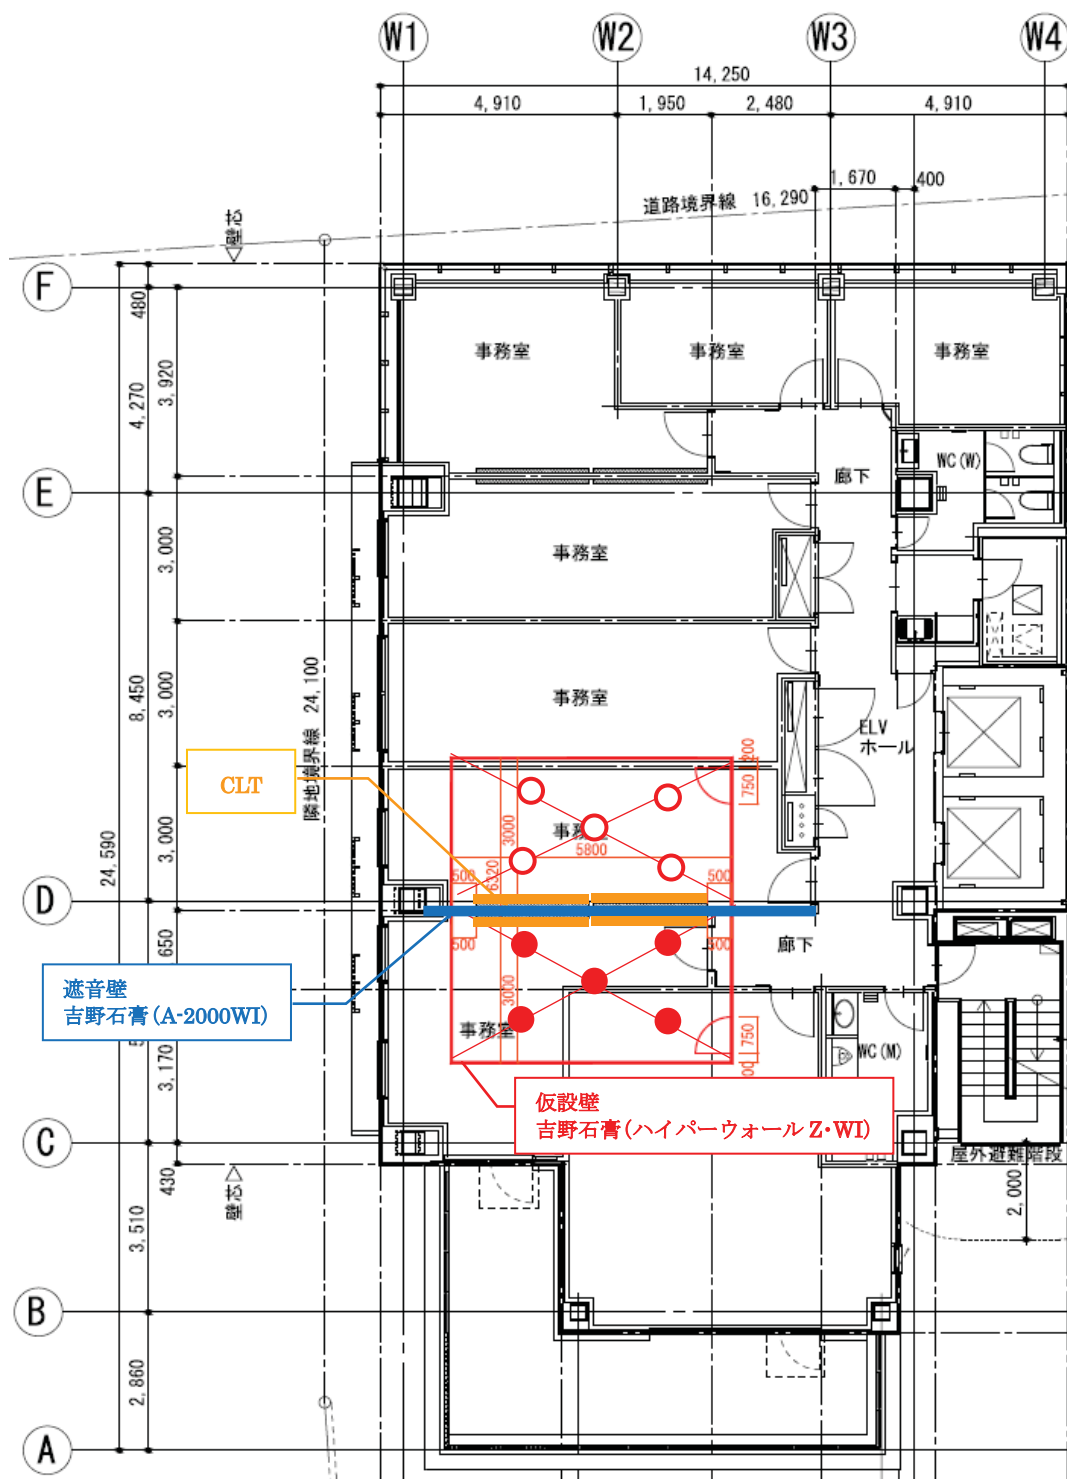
測定位置 (3 階平面図) (● : 音源室, ○ : 受音室を示す)
